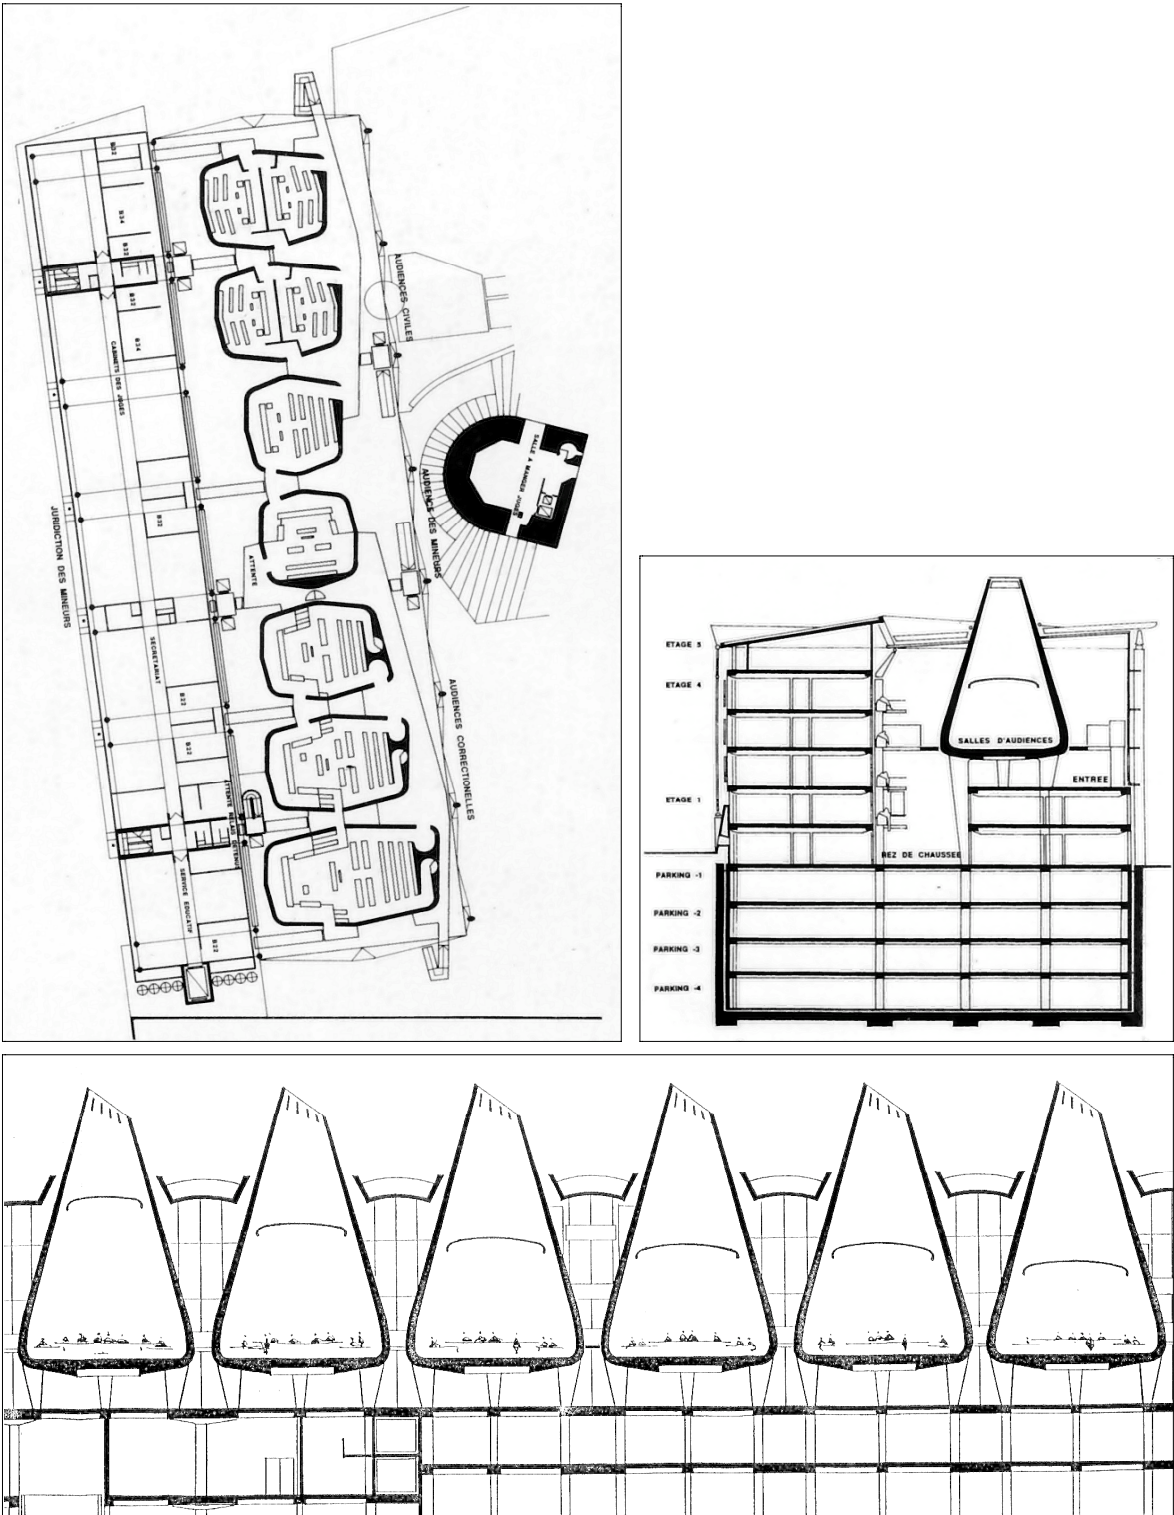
Plan au niveau des salles d'audience, coupe transversale et coupe longitudinale sur les salles d'audience
